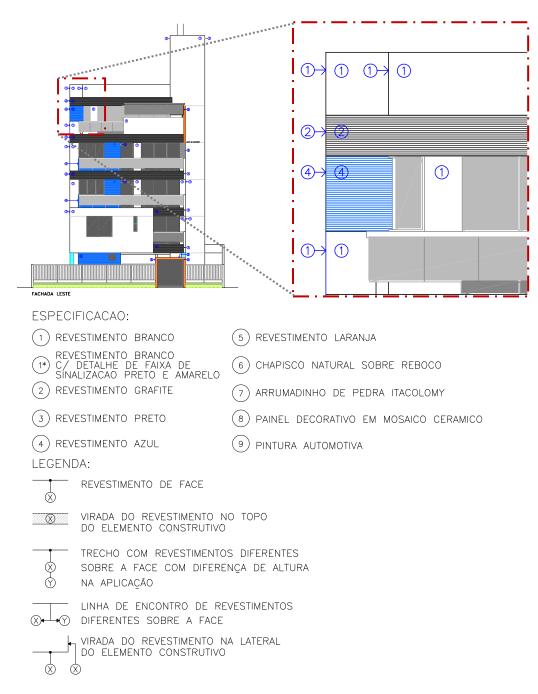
Exemplo de mapeamento do revestimento externo em planta baixa
